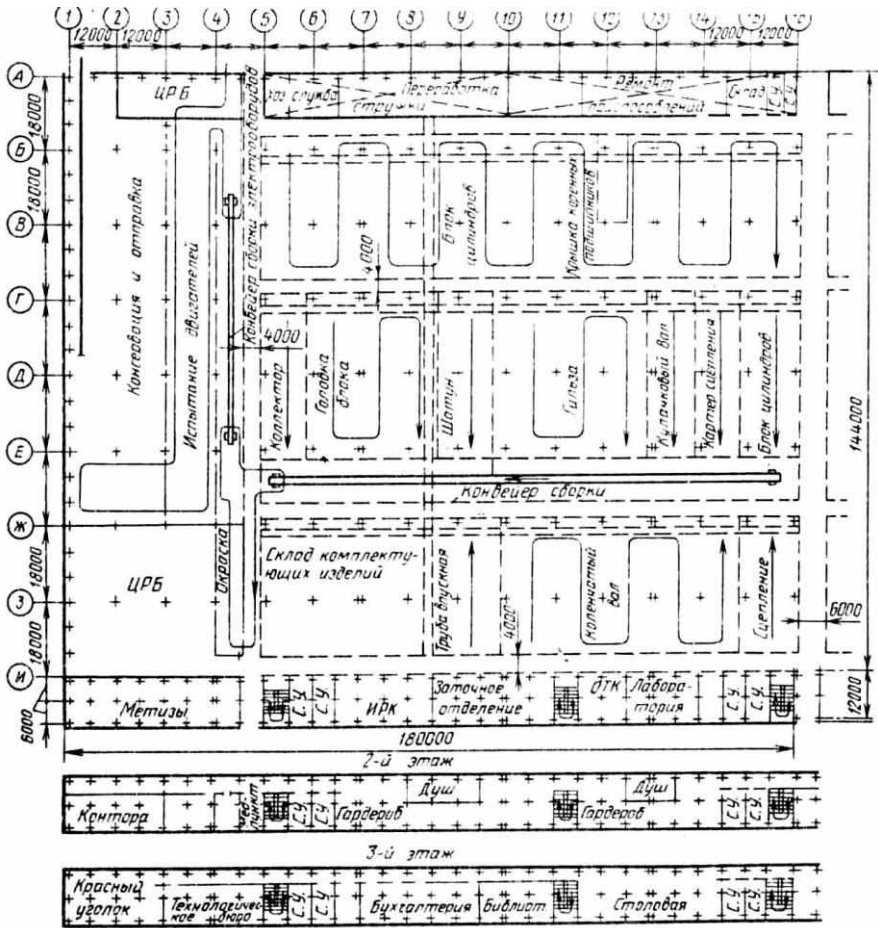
Компонировочный план корпуса по производству автомобильных двигателей
